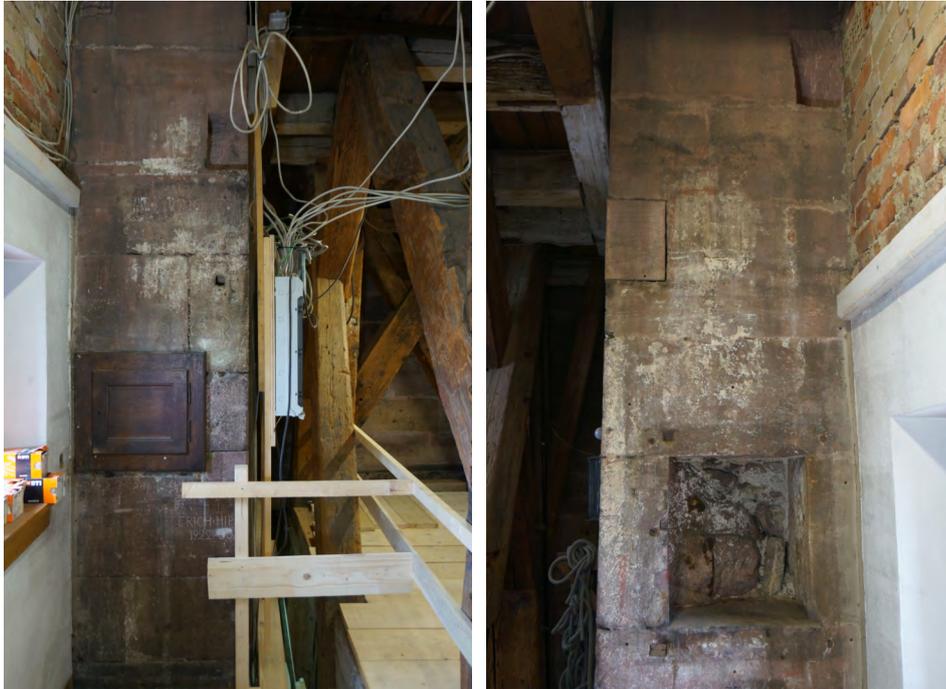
Türmerstube Westseite. Zustand während der Freilegung. Ins Mauerwerk eingelassene Schranknischen. Zahlreiche Inschriften und Zeichnungen zieren die Mauerfläche
